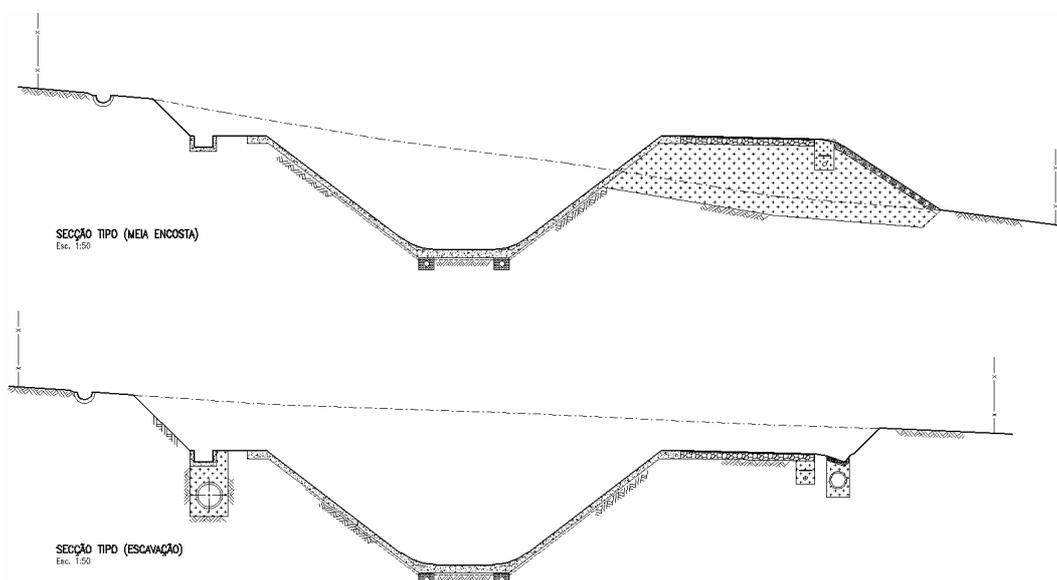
Perfis transversais tipo dos canais. Secção em escavação e a meia encosta.
